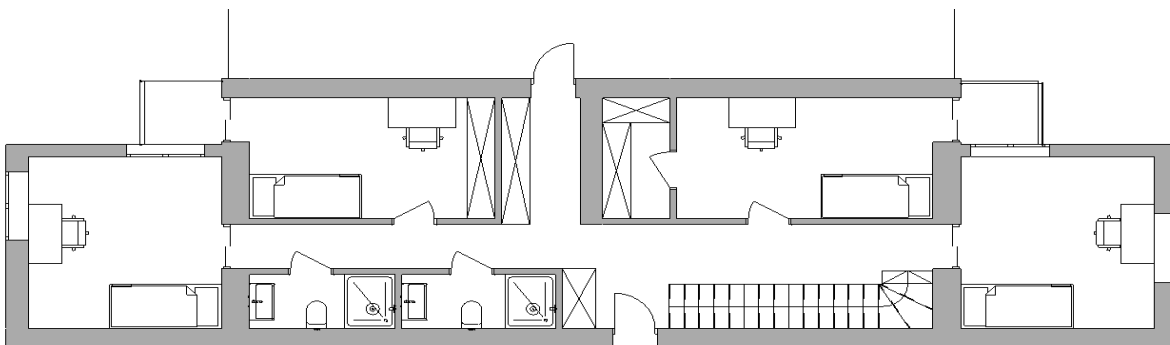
План 2 поверху дворівневого коворкінгу (7 поверх будівлі)
